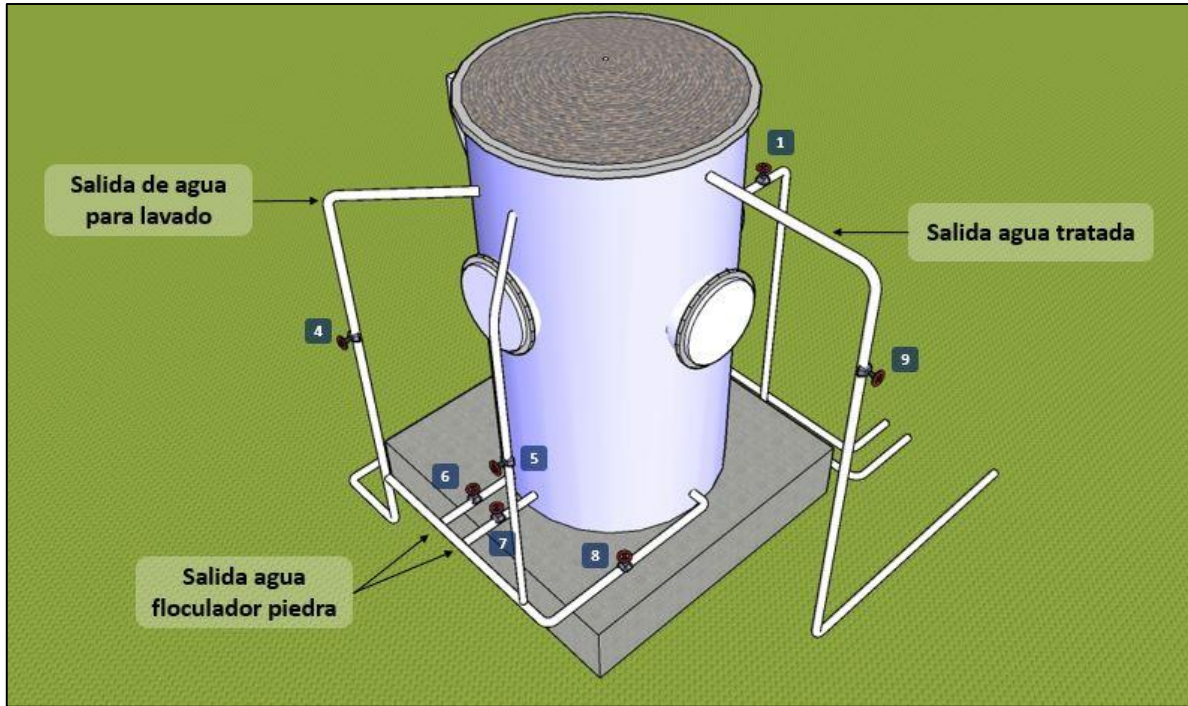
Esquema posterior planta $Q=0,5$ L/s
